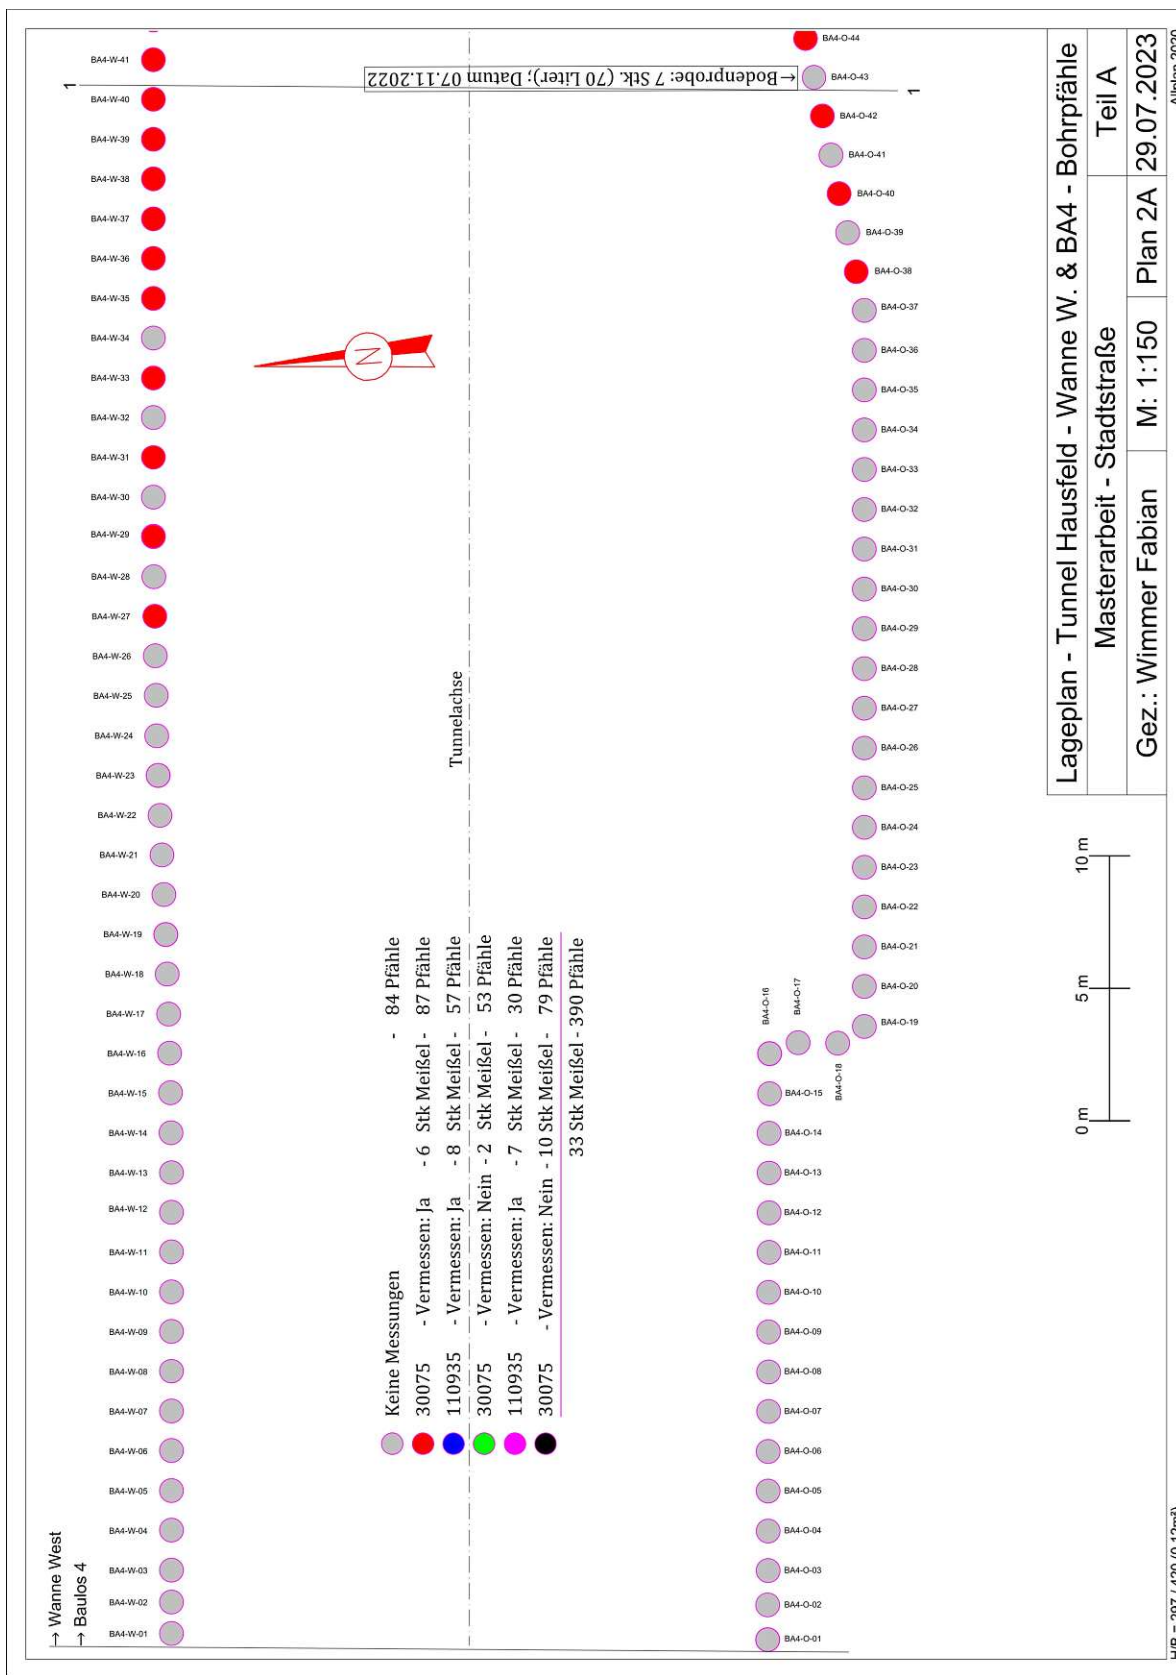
Lageplan - Tunnel Hausfeld, Wanne West und BA4 - Detailansicht Plan 2A; Plangrundlage [15]
